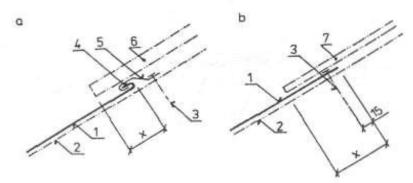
Priklad nadpojenia, pripevnenia a oplechovania odkvapu striech s povlakovou krytinou z asfaltovaných pásov s alternatívnym riešením príponky a ukon-
